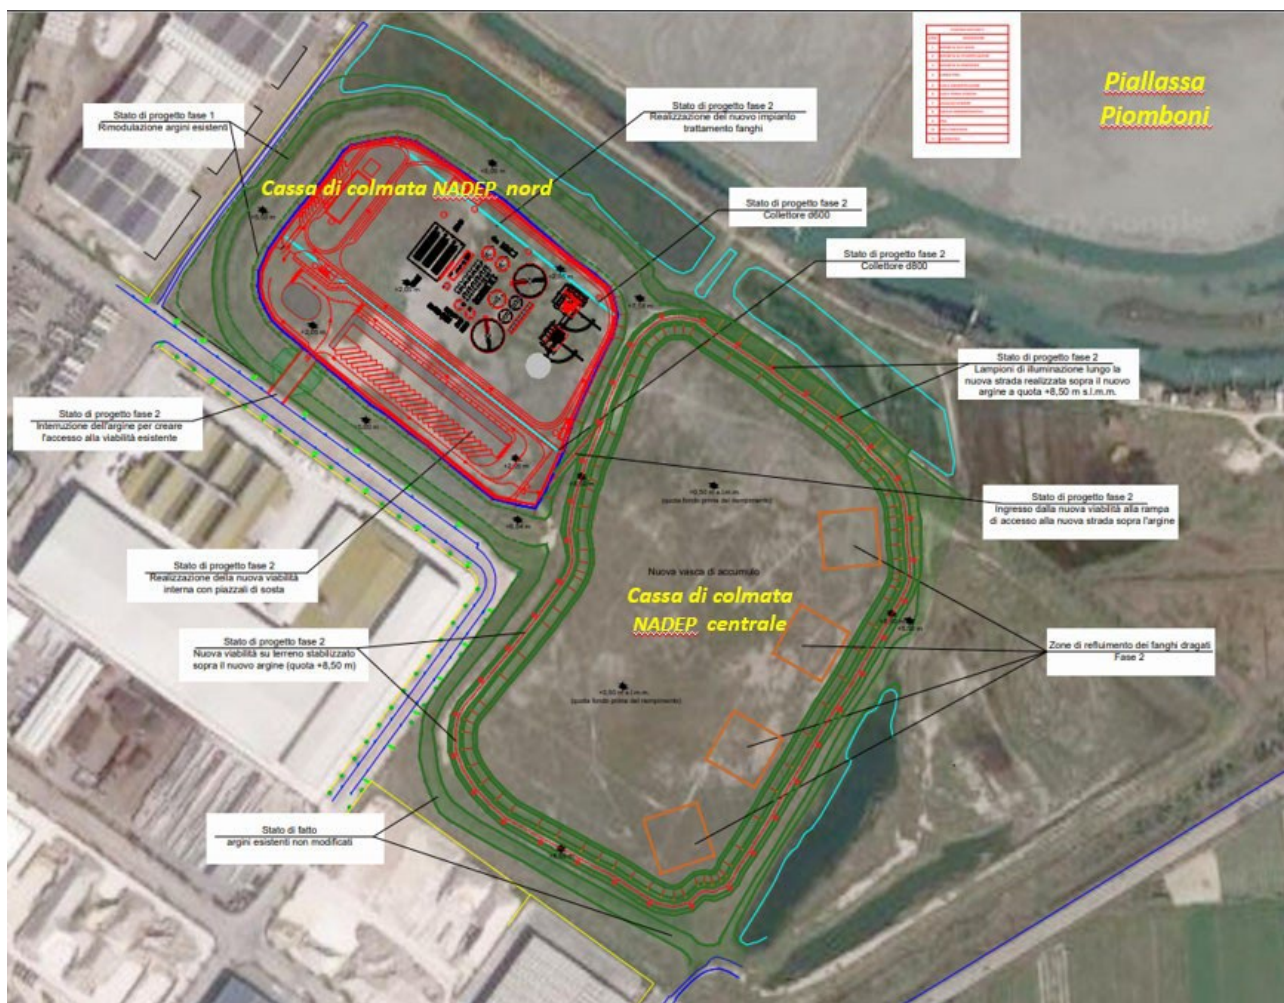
Articolazione progettuale dell'impianto di trattamento
